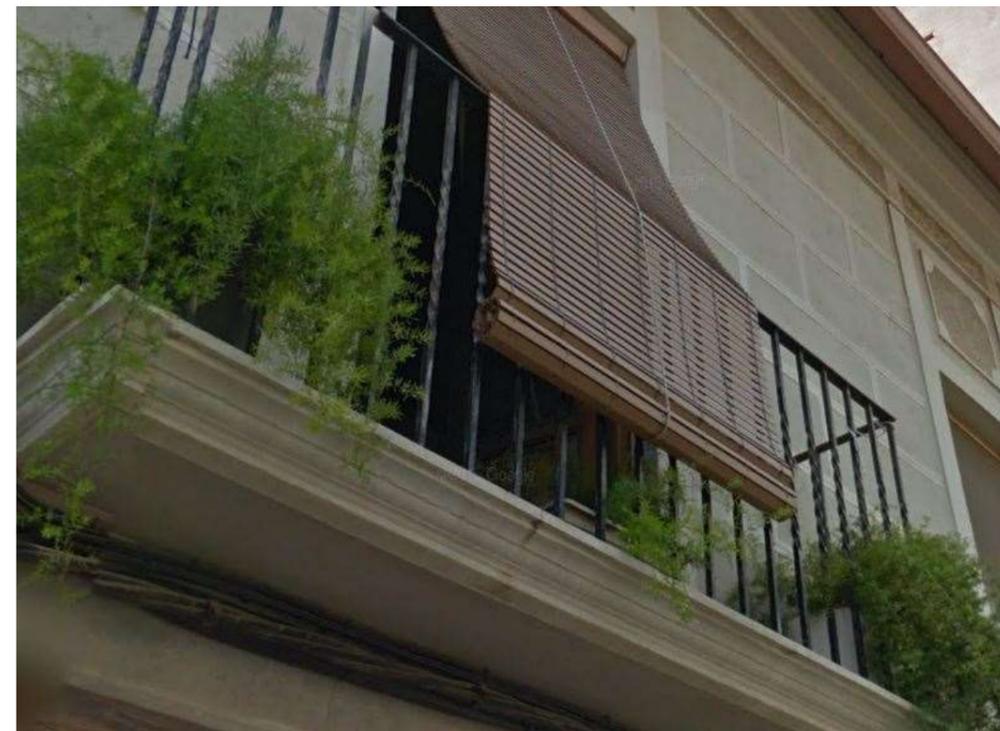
fotografía de la cerrajería correspondiente al balcón de la fachada principal.
